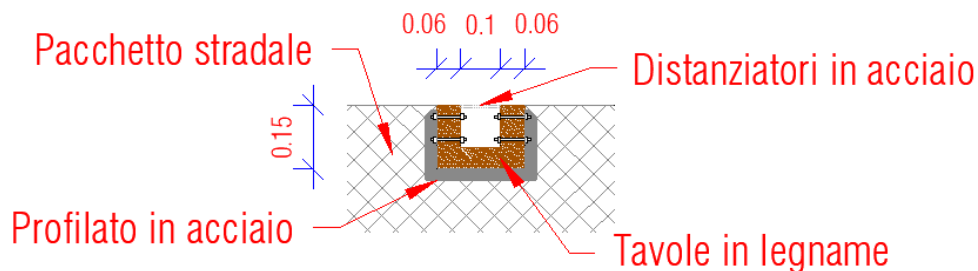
Estratto dalla tavola di progetto - Canaletta trasversale
